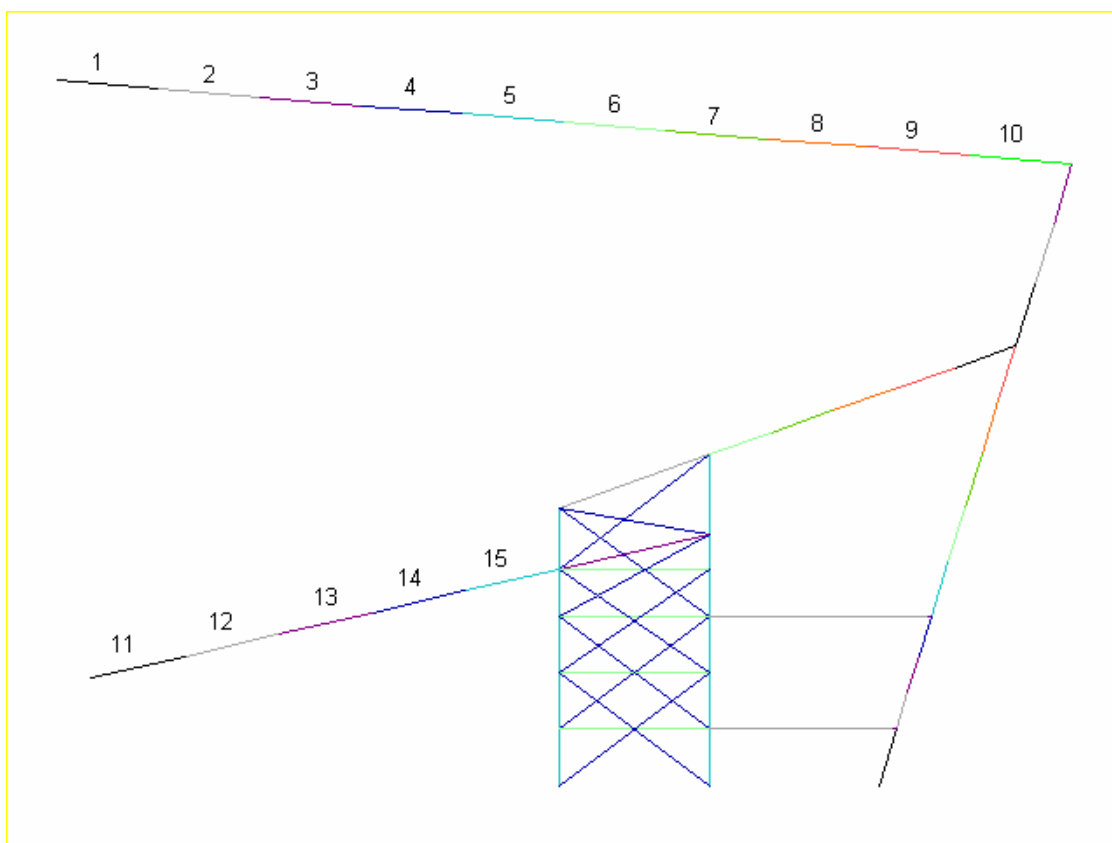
Modelo estrutural, em pórtico plano
